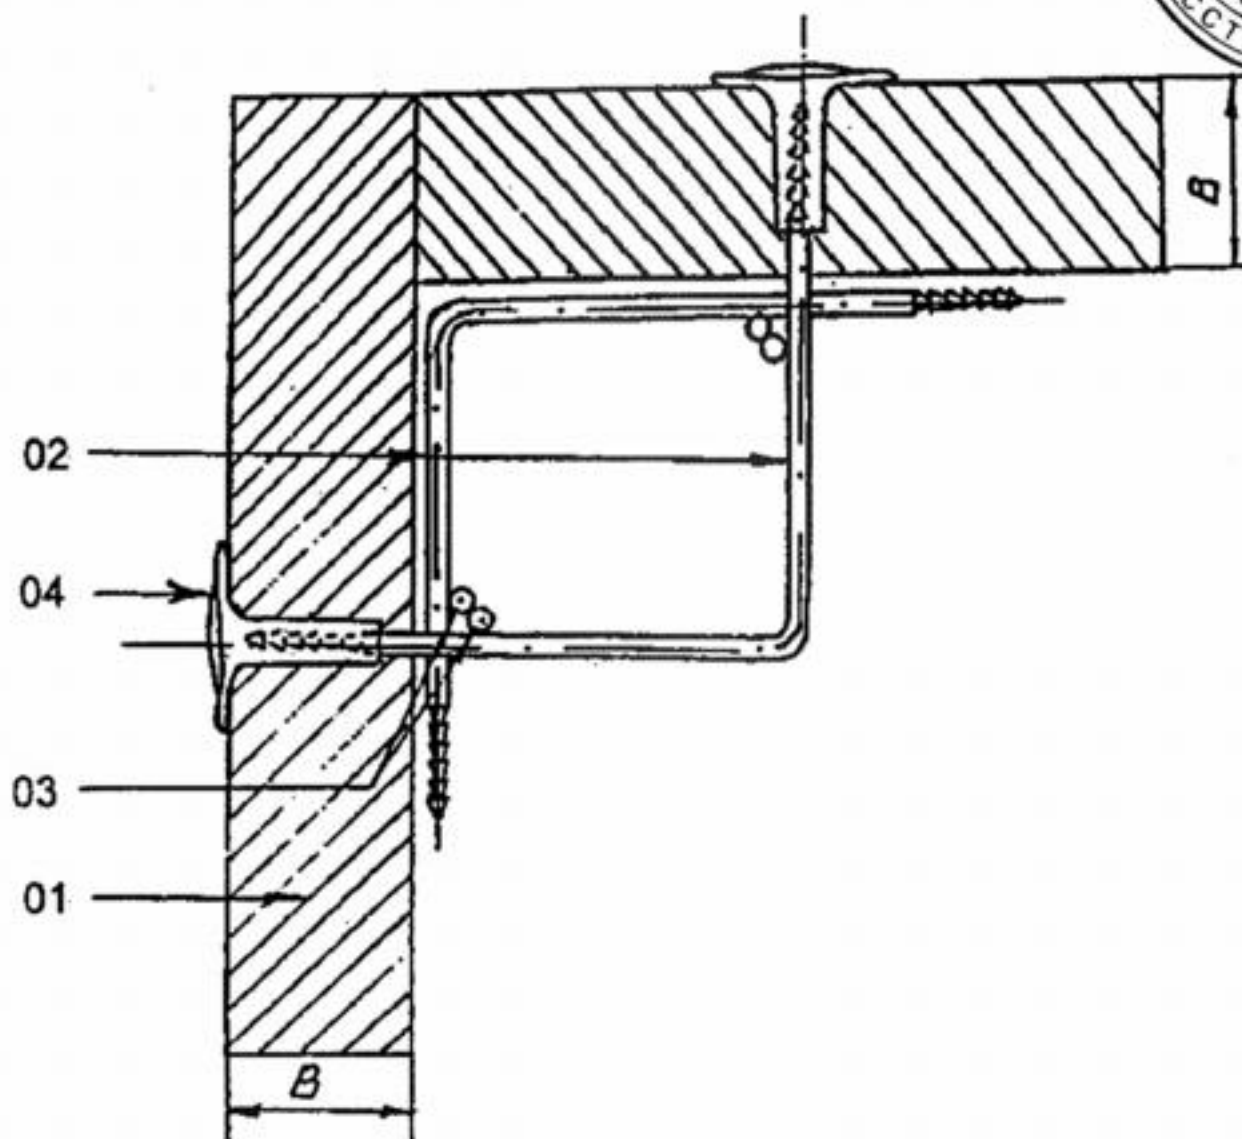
Рядовой элемент опалубочный наружной стены
